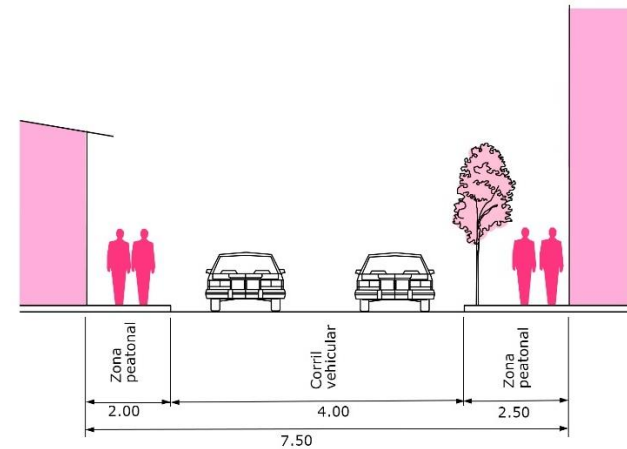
Perfil de acera calle central norte. Fuente: Elaboración propia
